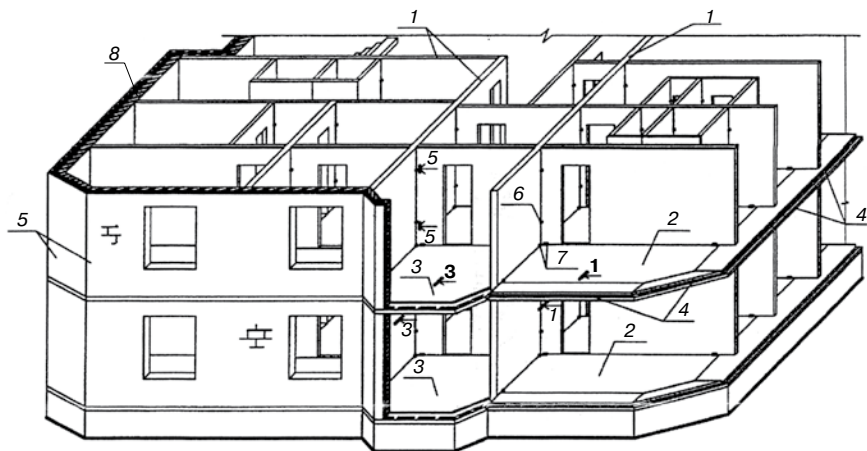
Схема здания со смешанной сборно-монолитной конструктивной системой из панельно-рамных несущих элементов индустриального изготовления: 1 – продольные и поперечные панели-рамы; 2 – плиты перекрытия; 3 – плиты перекрытия с перфорированным краем; 4 – ригели с терморазъемами; 5 – наружные самонесущие на 1 этаж стены; 6 – арматурные выпуски; 7 – бетон замоноличивания; 8 – связи между панелями
